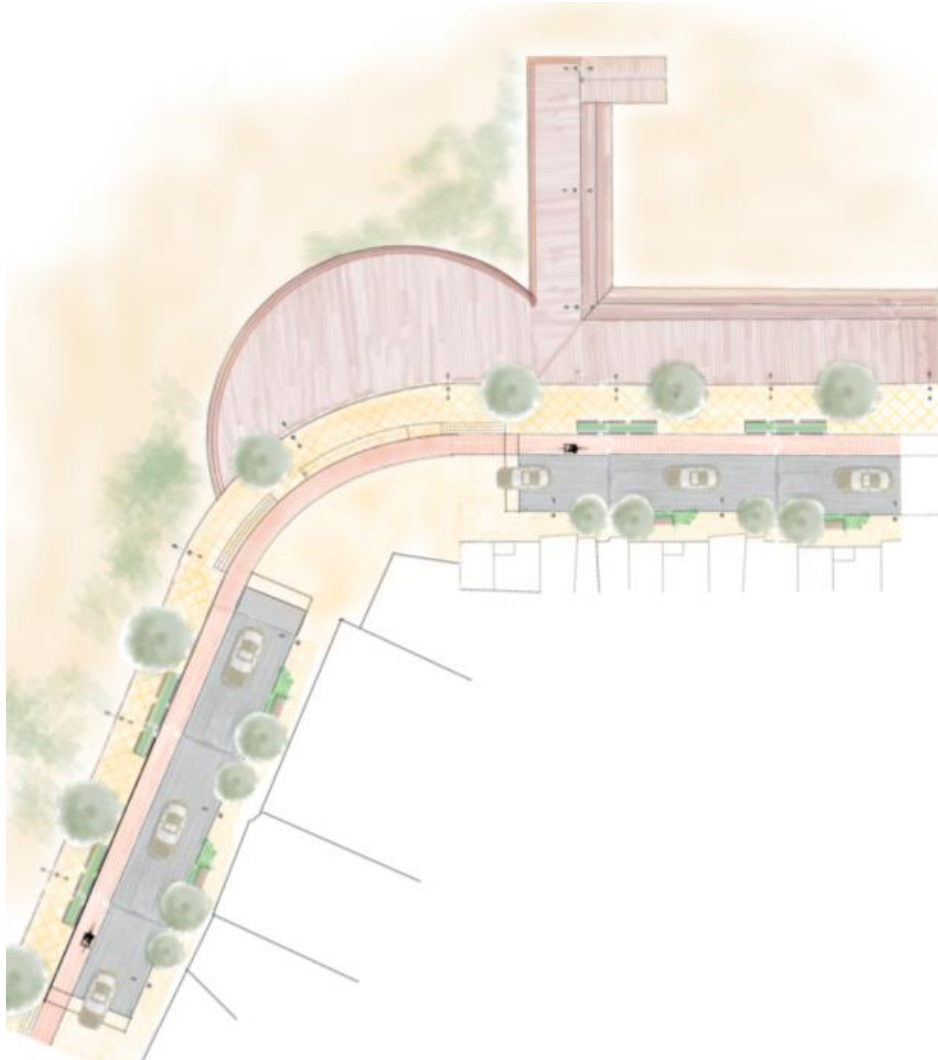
Planta e perspectiva da Plataforma - Tipo 02
